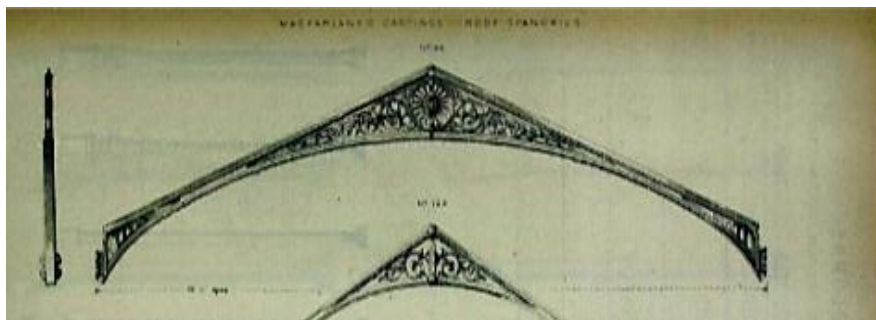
Elemento encontrado, semelhante ao existente na estação Brás, na Seção *Roof Spandrils*, *MacFarlane's Castings*, p. 566
